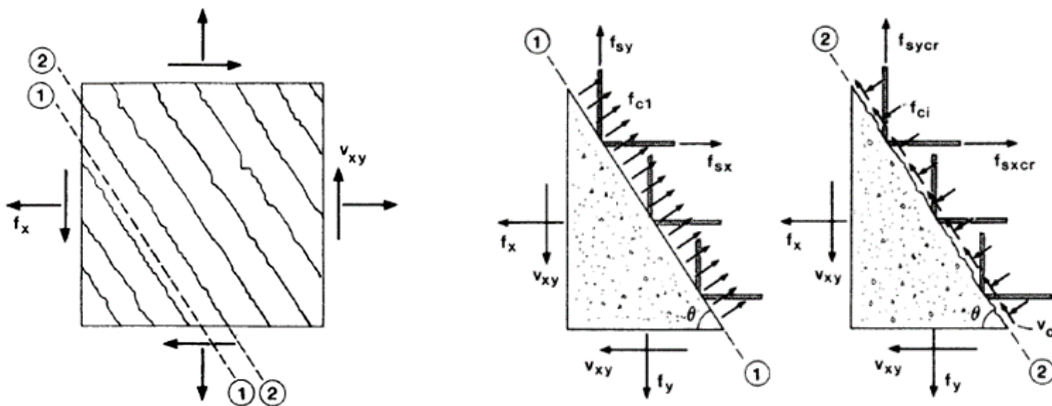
Tensões médias comparadas com tensões locais no plano entre fissuras e plano na fissura (VECCHIO e COLLINS, 1986).
